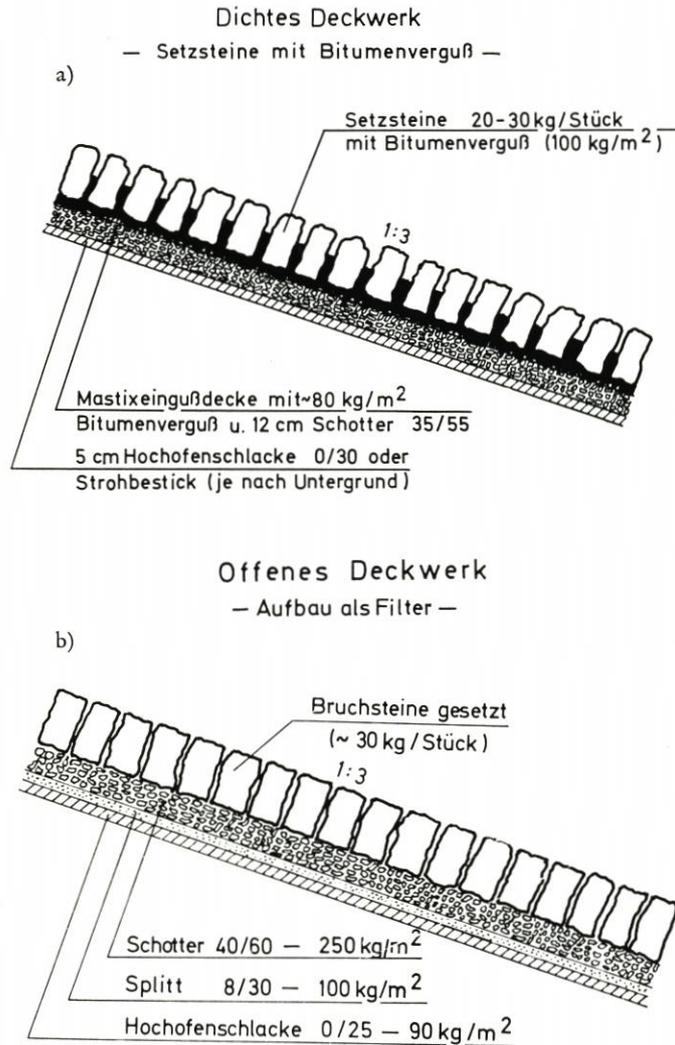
Deckwerksaufbau, a) geschlossen, b) offen
